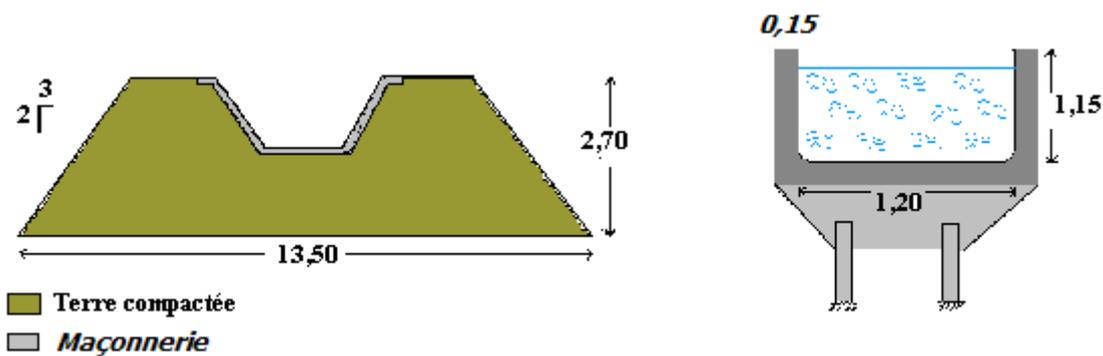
Coupe transversale des options sur le canal secondaire S1
